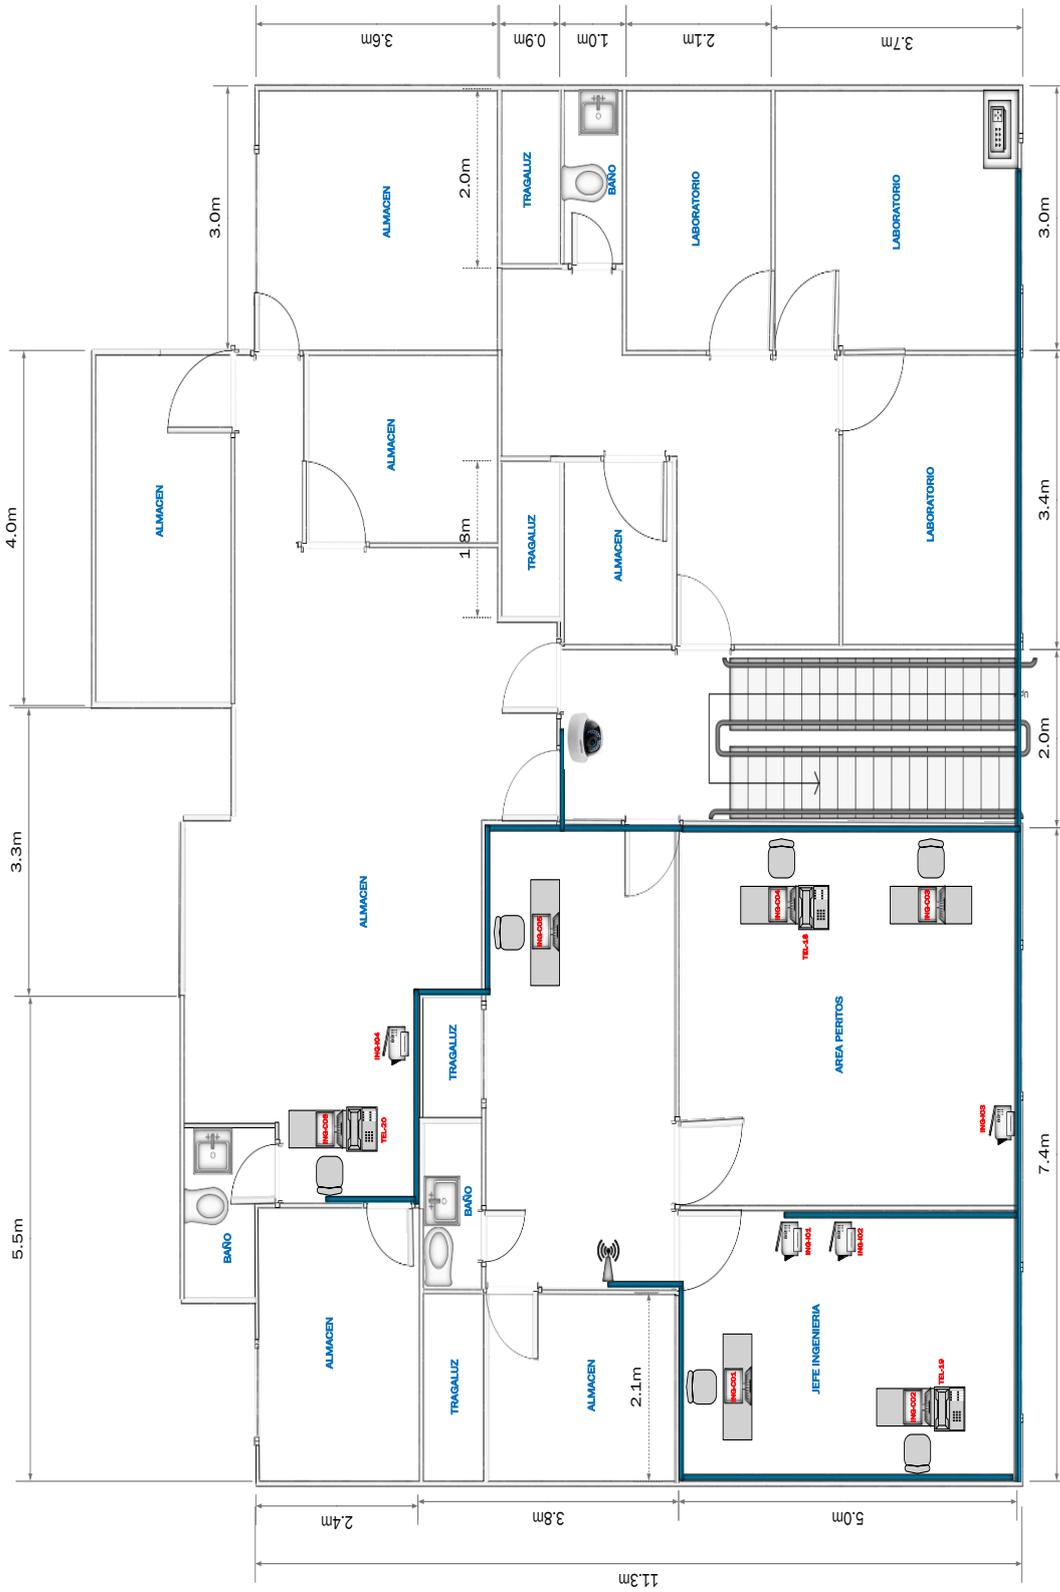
Plano del Edificio N°2-Piso N°3 con recorrido de canaletas
